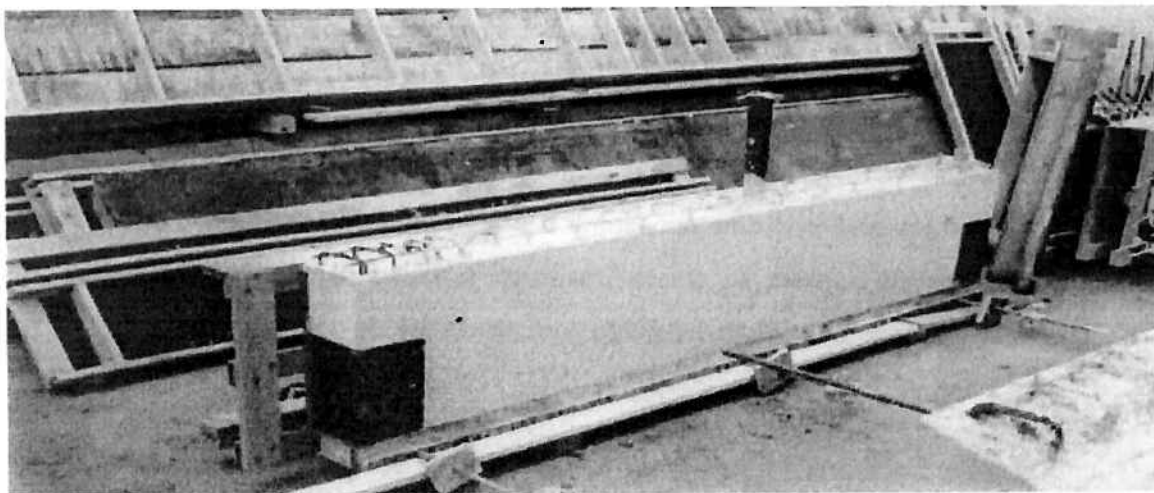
Pré-viga recém-concretada e desformada, mostrando um eletroduto passante e os insertos metálicos que farão os dentes na viga e que apoiar-se-ão em outras vigas
